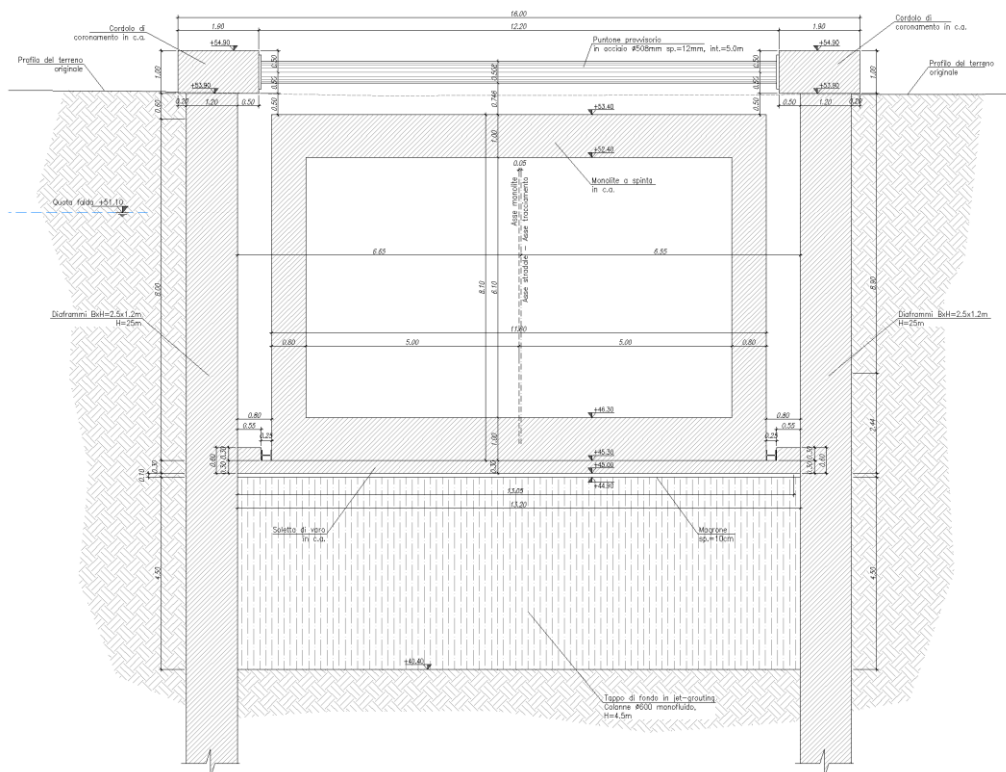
Sezione tipo tra diaframmi in area di varo
